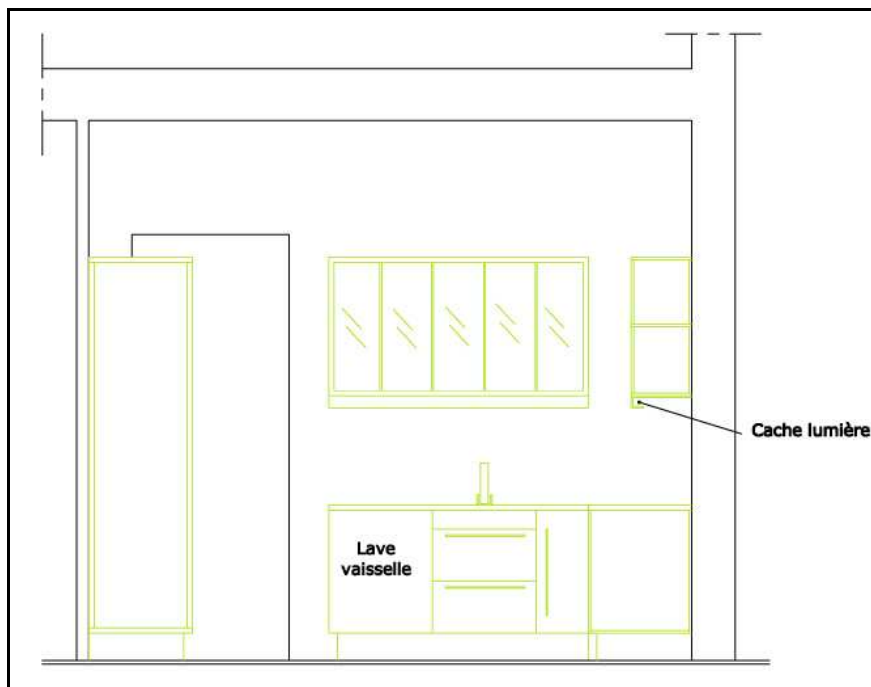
Deuxième proposition de la coupe élévation C-C : modifications au niveau des hauteurs des rangements, au niveau du découpage des éléments de rangements ainsi que pour la baie fixe (proposition retenue)
